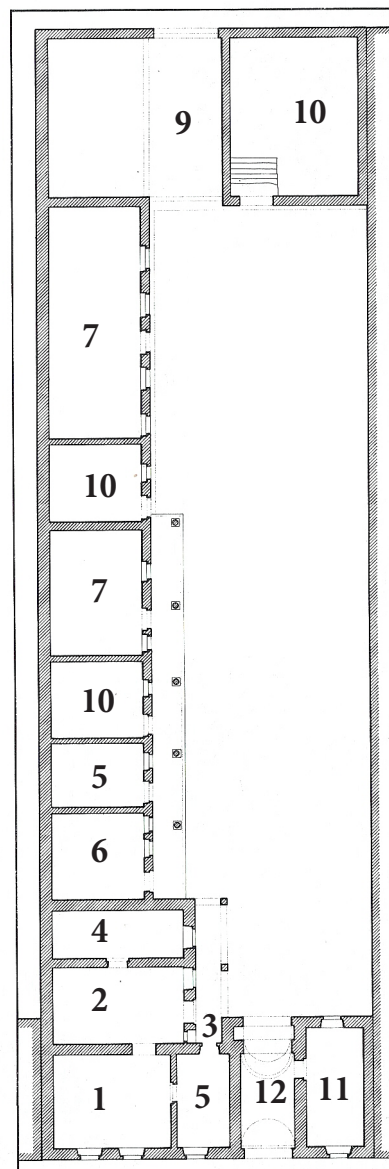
Eine möglicher Grundriss eines Zwerchhofes.
